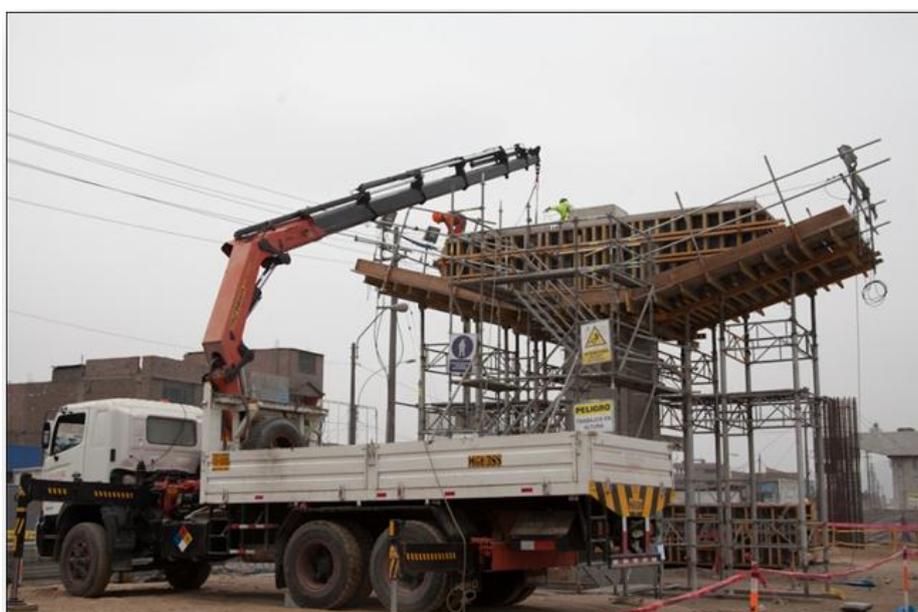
Proceso constructivo de vigas cabezales in situ.
